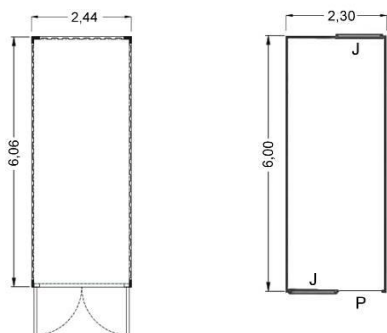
a- Planta baixa do contêiner porta dupla e b- planta baixa do contêiner vão livre. Fonte: www.lafaetelocacao.com.br.
